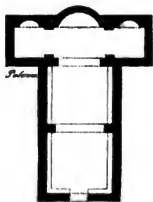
Grundriss von S. Giovanni degli Eremiti zu Palermo. (Nach Serradifalco.)
